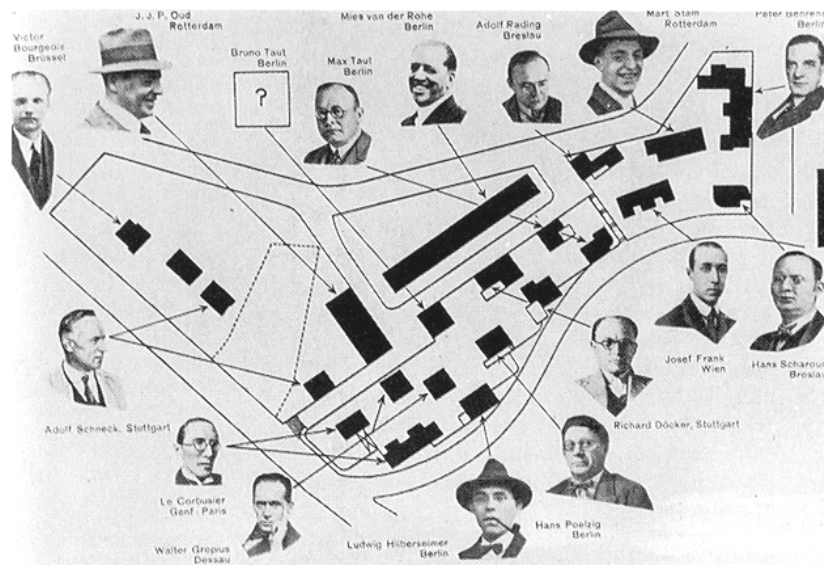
PLANTA DO LOTEAMENTO DE *WEISSENHOFF*, STUTTGART, 1927
